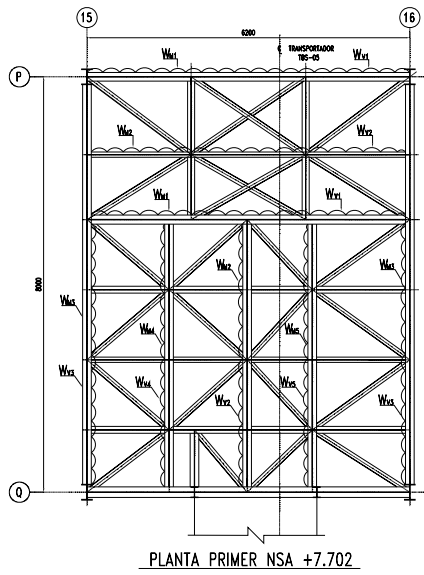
Plantas de Operación TT-4, con cargas distribuidas y estructuración
